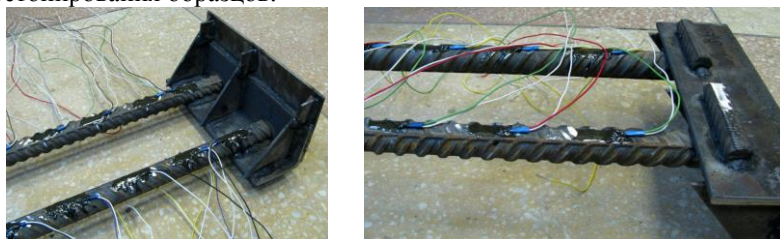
Гидроизоляция тензорезисторов на арматуре
